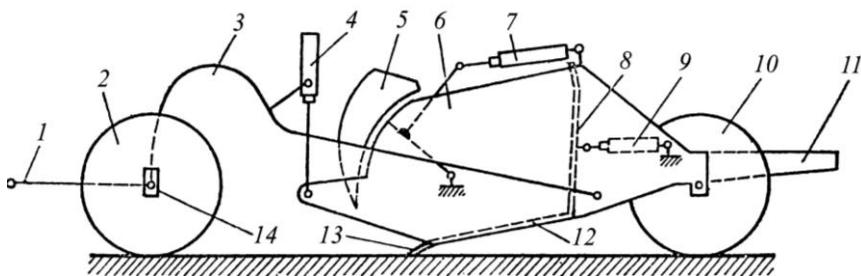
Схема прицепного двухосного скрепера:
